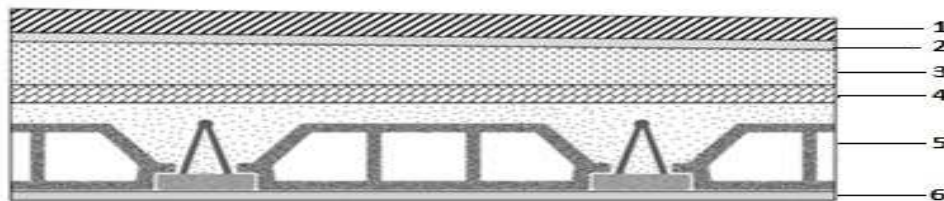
Coupe verticale du plancher terrasse à corps creux
